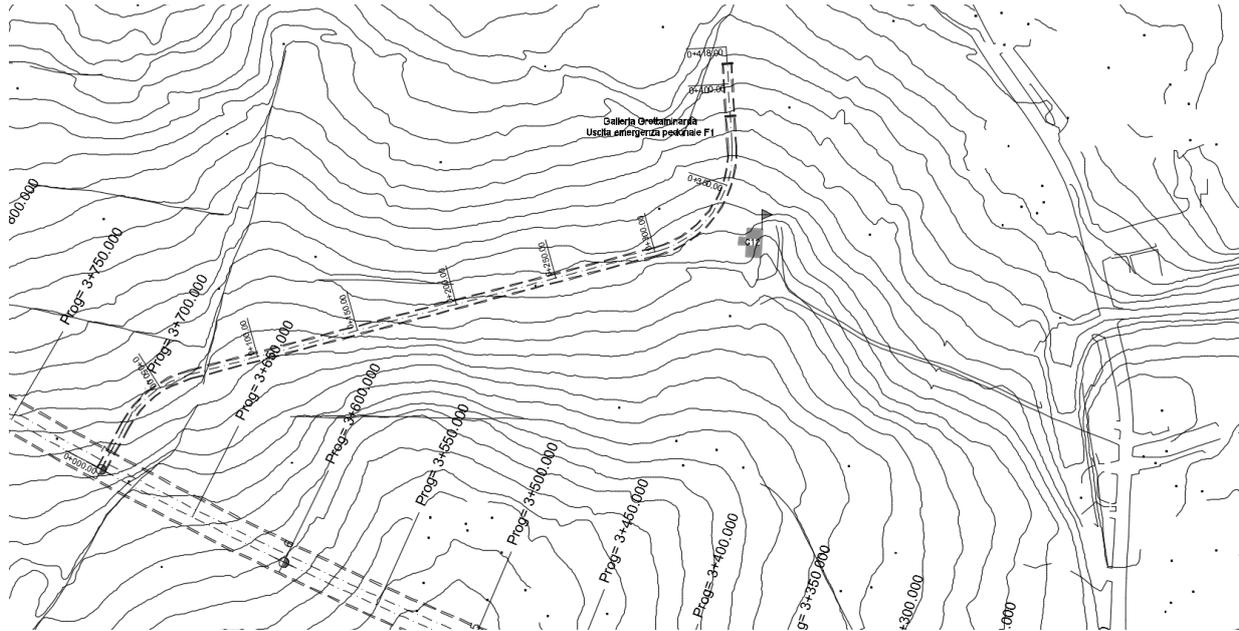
Planimetria posizione edifici zona galleria galleria Grotta Minarda - Finestra F1
